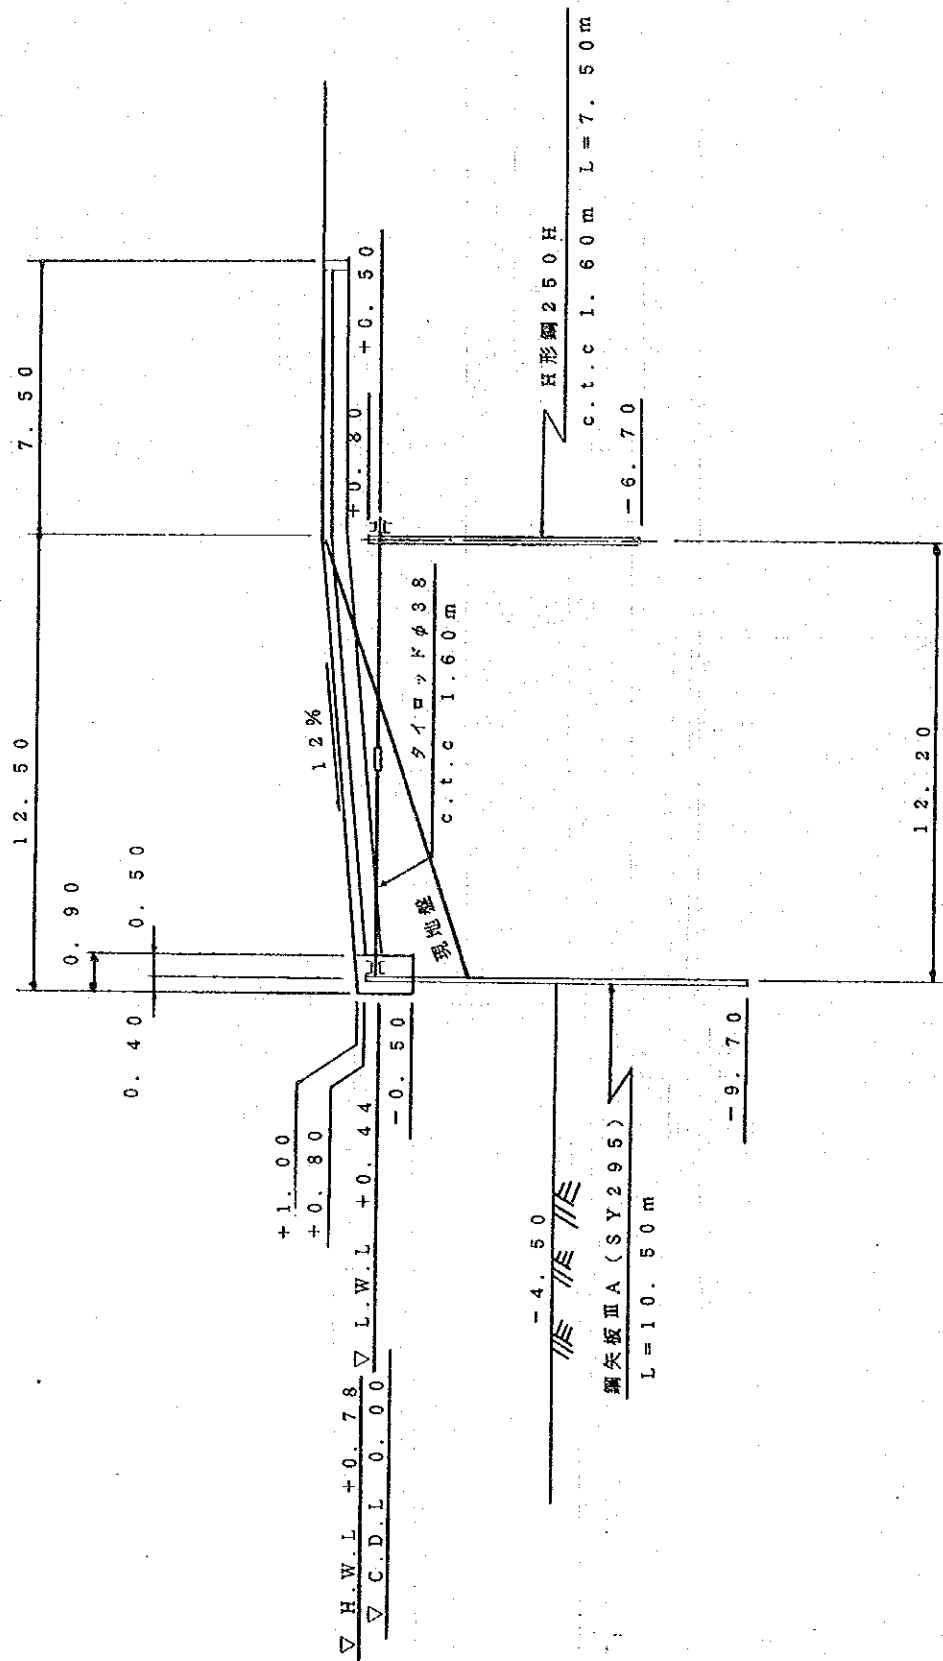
A 岸壁リターン部標準断面図 (斜路部)
